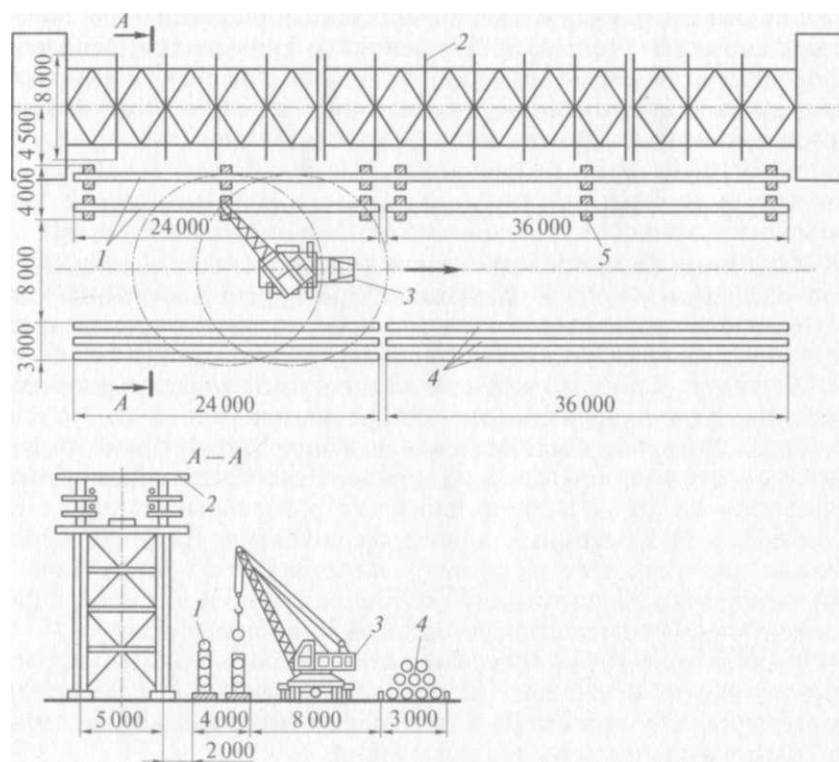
Схема перемещаемой площадки для сборки трубопроводных блоков:
